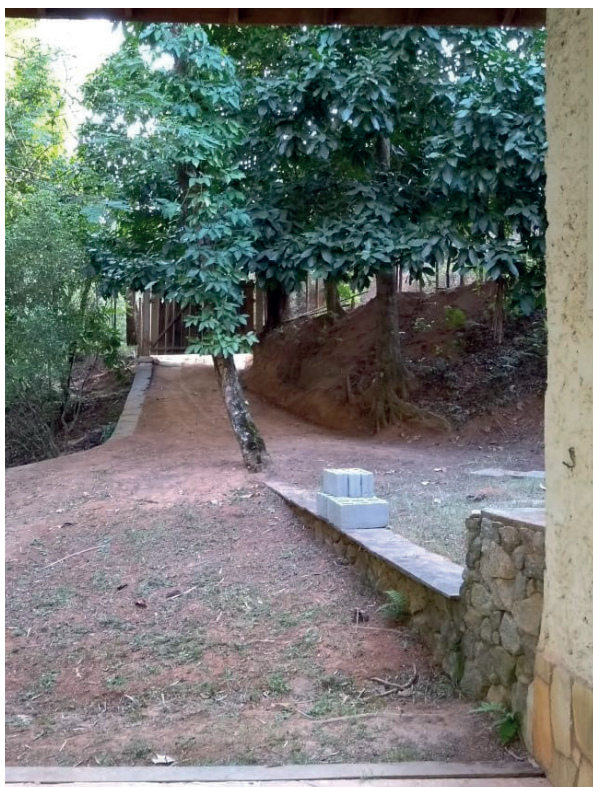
Área pavimentada interna de acesso à sede. Foto: Guilherme Sardenberg Barreto
